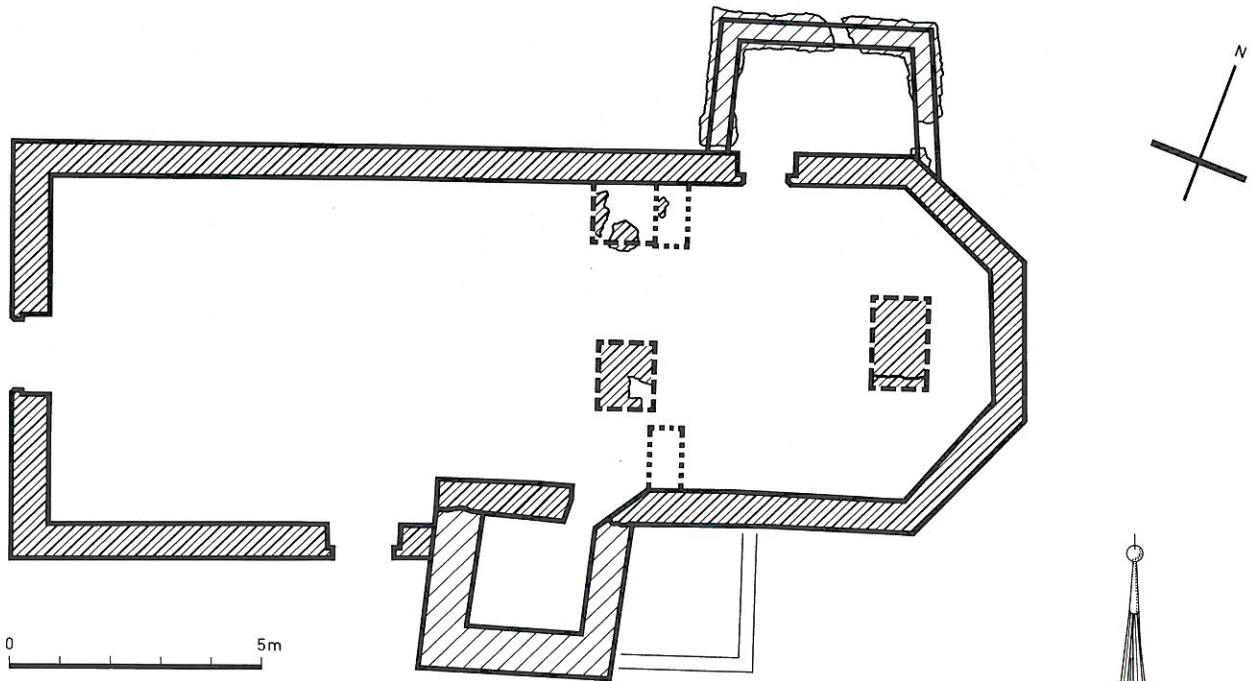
Rekonstruierter Grundriss der Kirche von 1514/15. M. 1:150.
